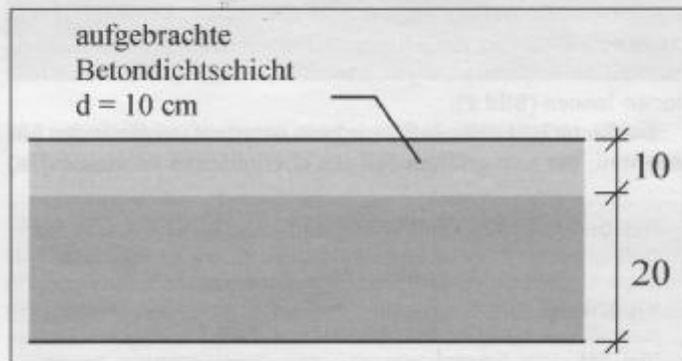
Sanierungsvariante 1 durch Herstellung einer zusätzlichen Betondichtschicht
